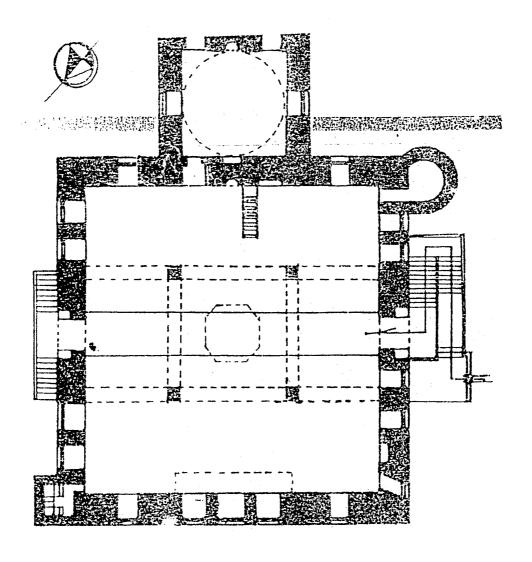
مسقط أفقي لمدرسة اينال اليوسفي بالقاهرة (عن صالح لمعي).
